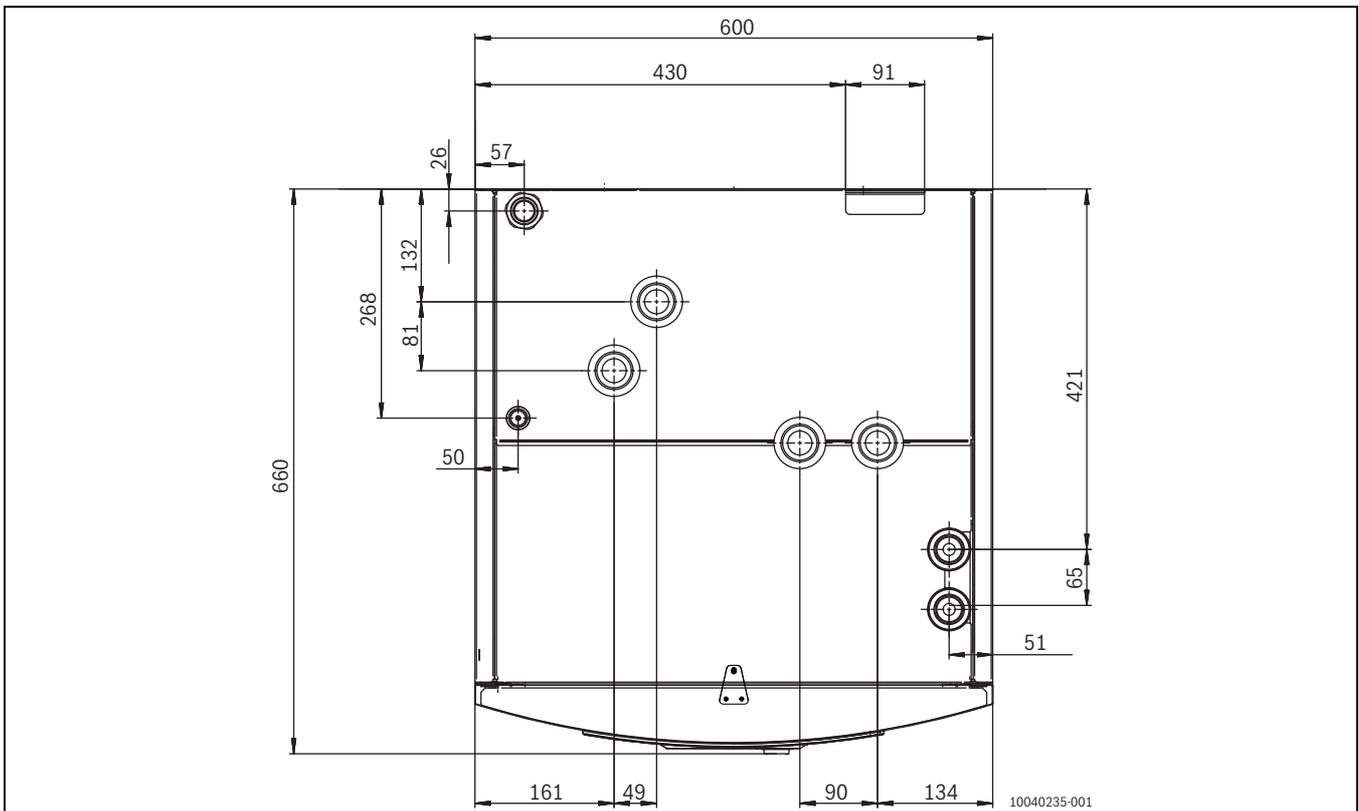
Anschlussabmessungen, Ansicht von oben (Maß in mm)
